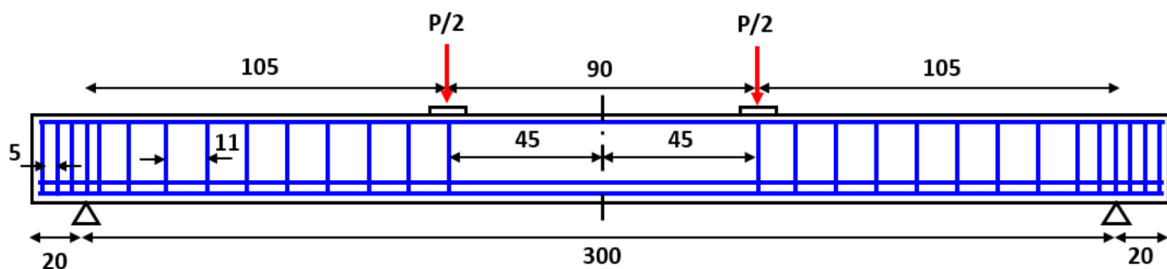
Configuração longitudinal padrão para vigas de Leonhardt e Walther (1962) (medidas em cm) (LAZZARI, 2016).
